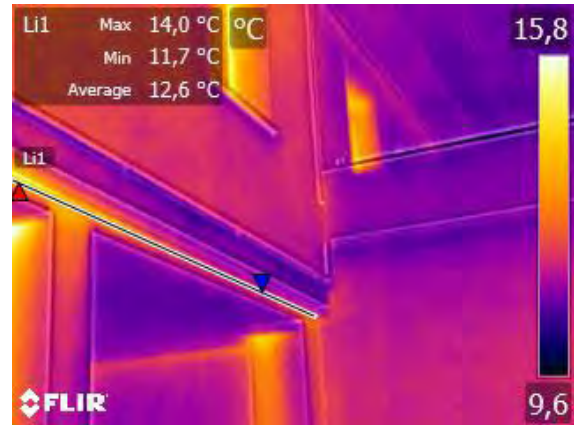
CA\_4: condizioni di rilevazione passive, fascia oraria 9-10. Prospetto sud. Sopra, a destra, documentazione fotografica di cantiere, particolare della posa di XPS sulle travi di piano e sotto alle aperture.
